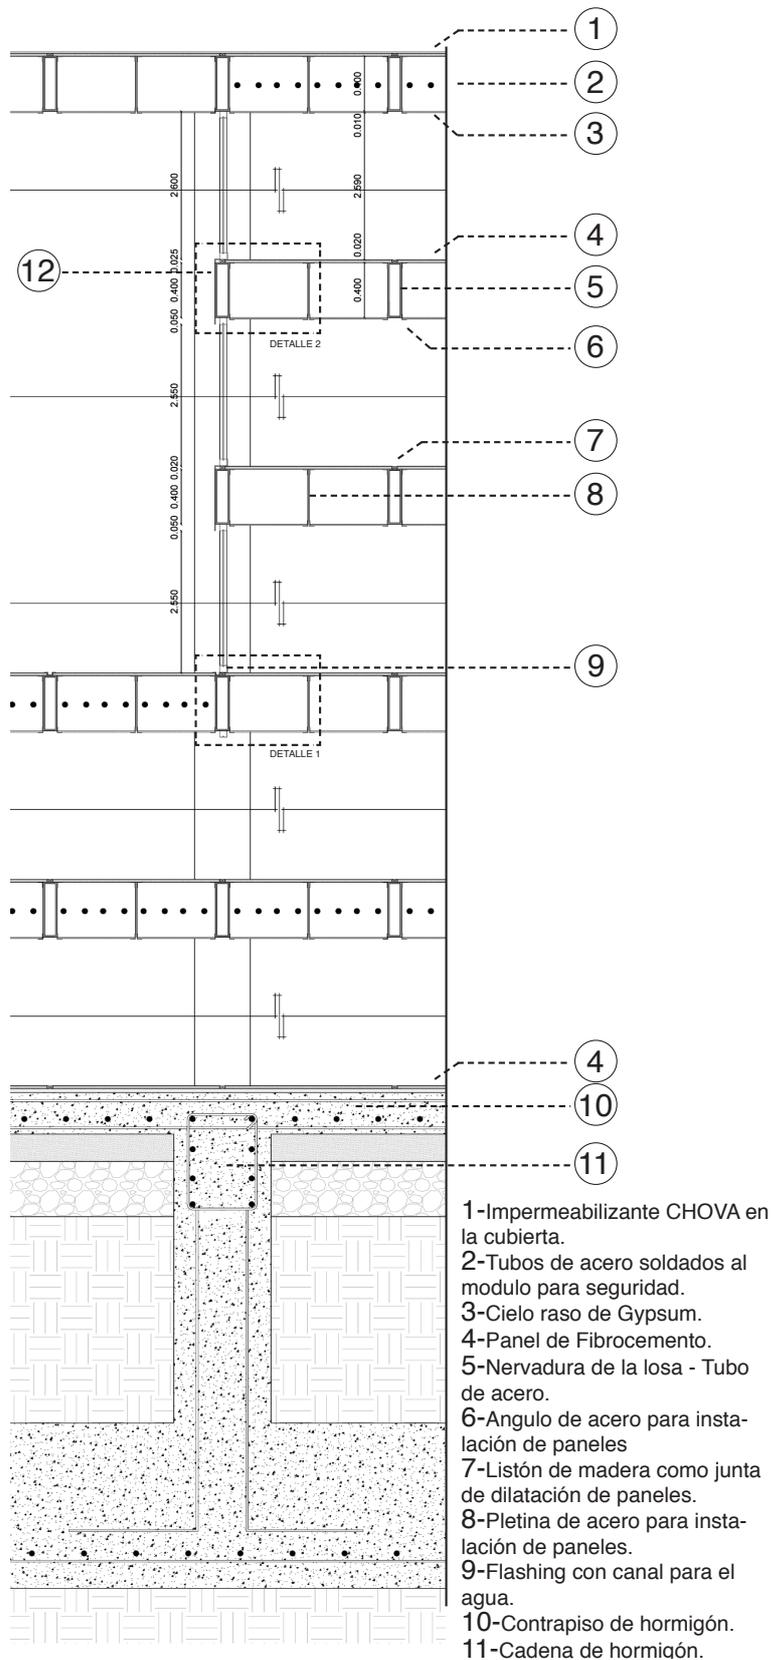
Corte por Fachada ESC. 1:50 (Elaboración Propia)
